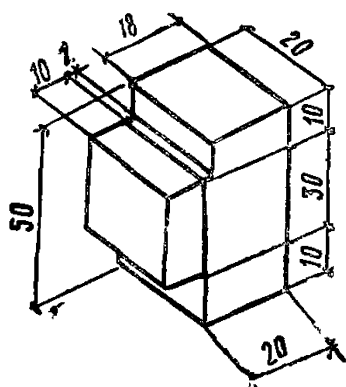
Образец для испытания клеевых соединений древесины на сдвиг при сжатии
